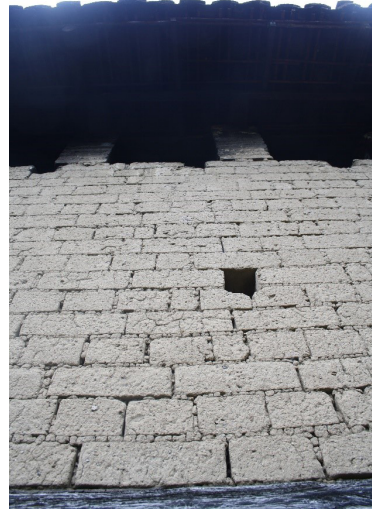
Detalle exterior casa de hacienda esclavista en el Cauca (Hacienda Mosquera), adobe de tierra en los muros y cubierta en teja de barro. Fuente: El autor.
